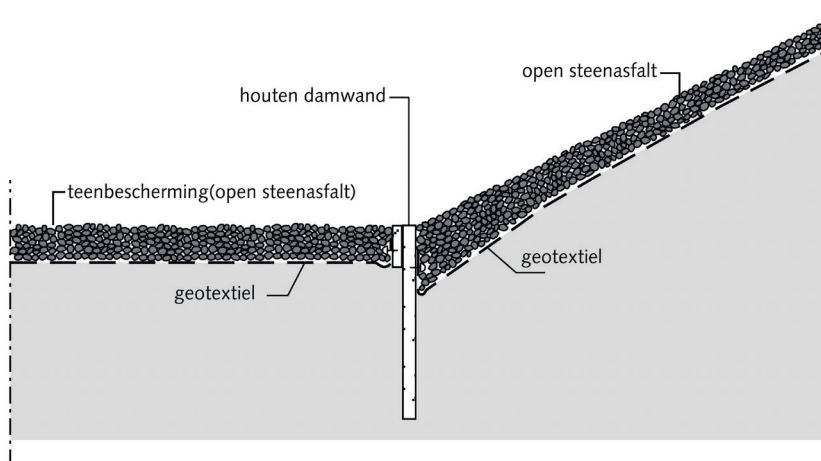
VOORBEELD VAN EEN OVERGANG TUSSEN TWEE ASFALTBEKLEDINGEN [1]
